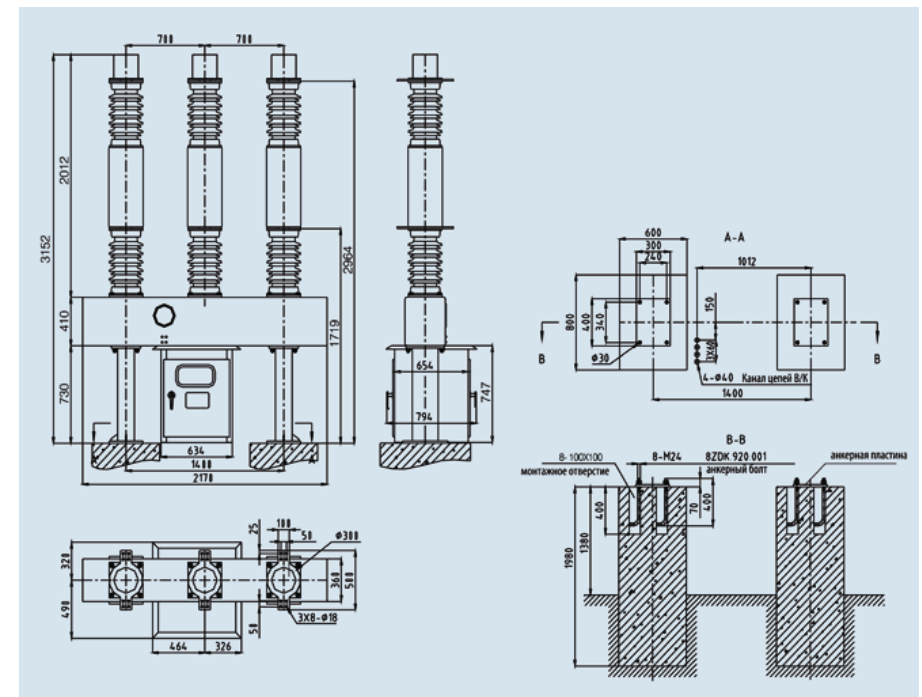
Внешний вид и размеры выключателя LW8-40/5
